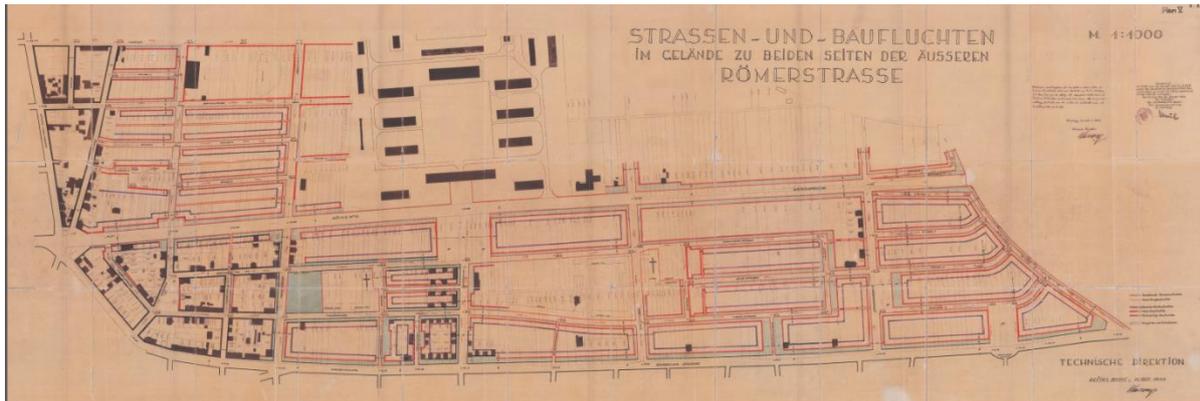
Ausschnitt Straßen und Bauflichtenplan mit Rechtskraft vom 06.04.1950
